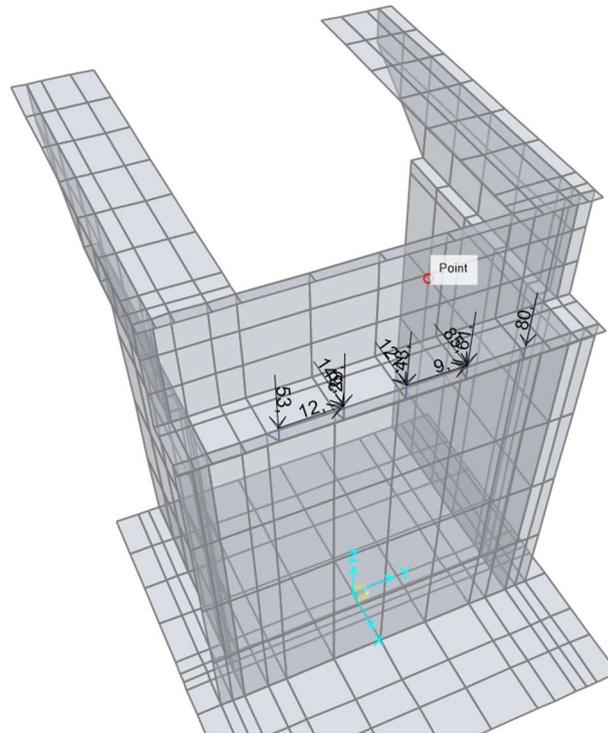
Modello FEM Finale – Vista assometrica carichi sismici in direzione -z trasmessi dall'impalcato su spalla fissa (Imp_sis_Z)
